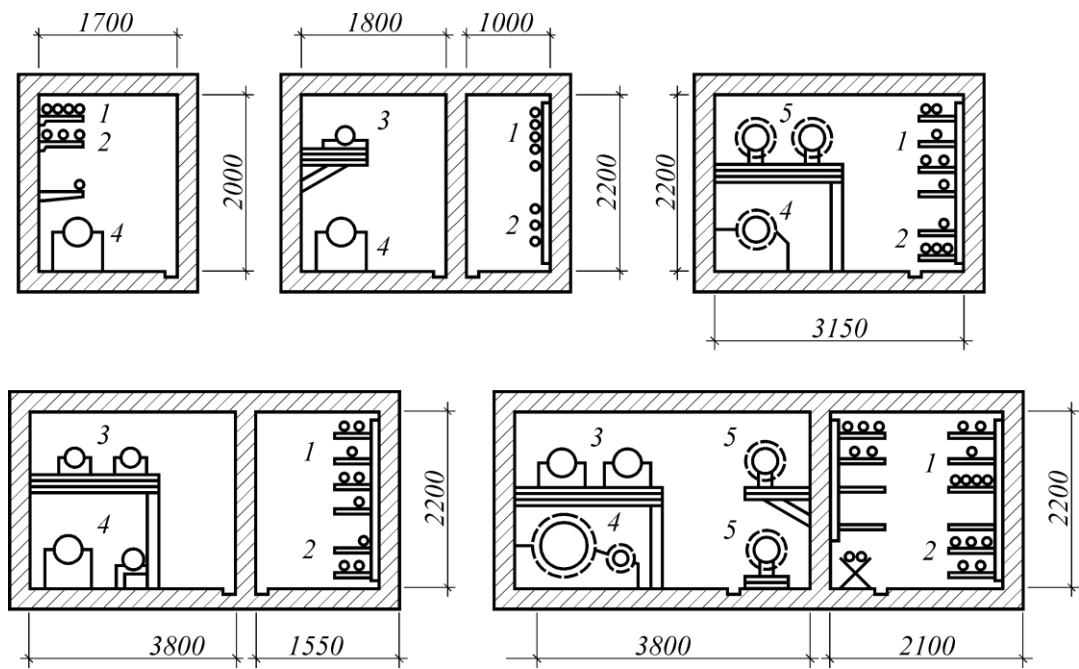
Перетин колекторів із збірних залізобетонних елементів для прокладання різних комунікацій: 1 – кабелі зв’язку; 2 – електрокабелі; 3 – газопровід; 4 – водопровід; 5 – трубопроводи теплопостачання
